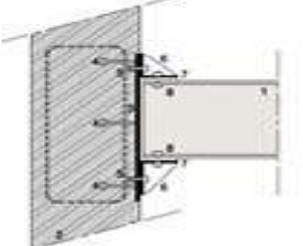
Segmento de placa de hormigón prefabricada
